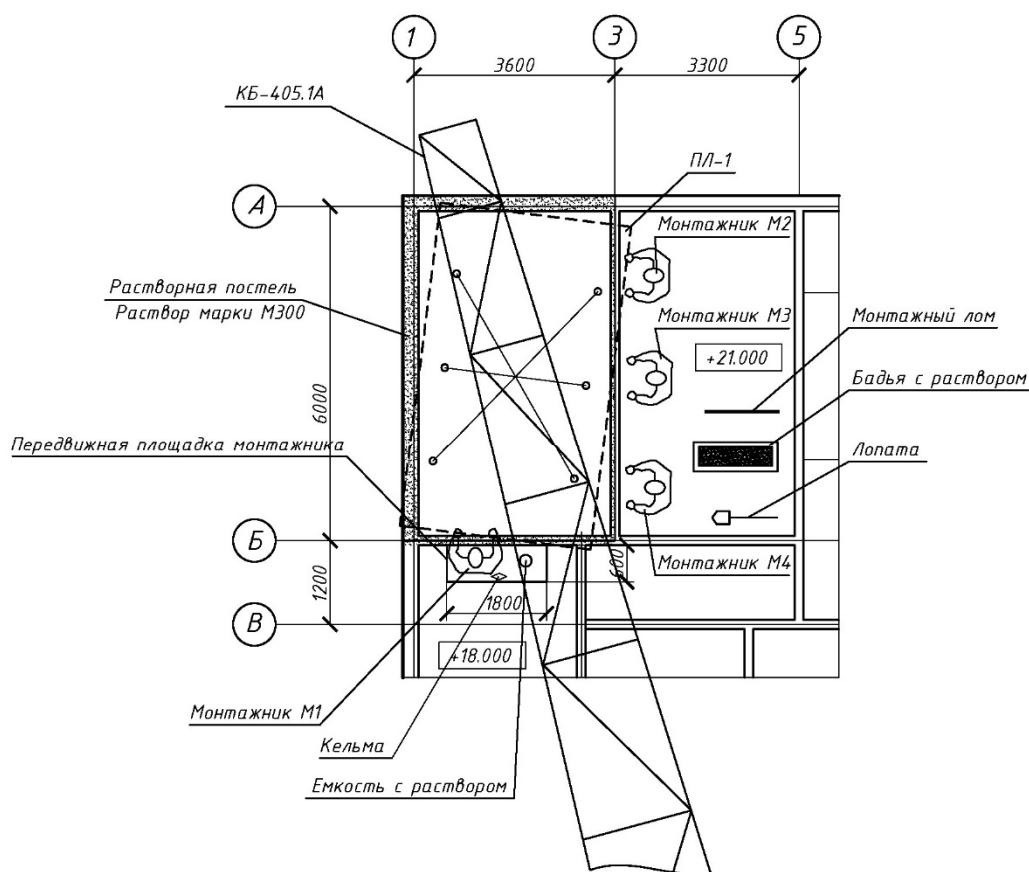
Схема монтажа плит перекрытия в плане.
